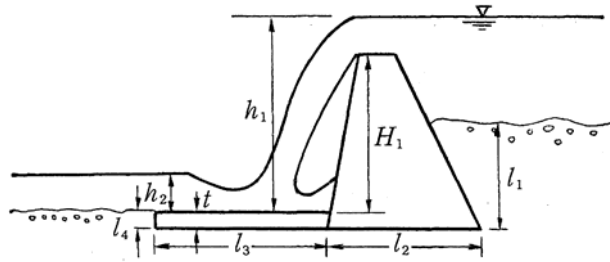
揚圧力から求める式による水叩きの厚さ
